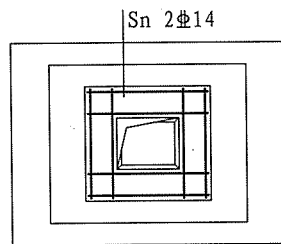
单杯口独立基础顶部焊接钢筋网示意
